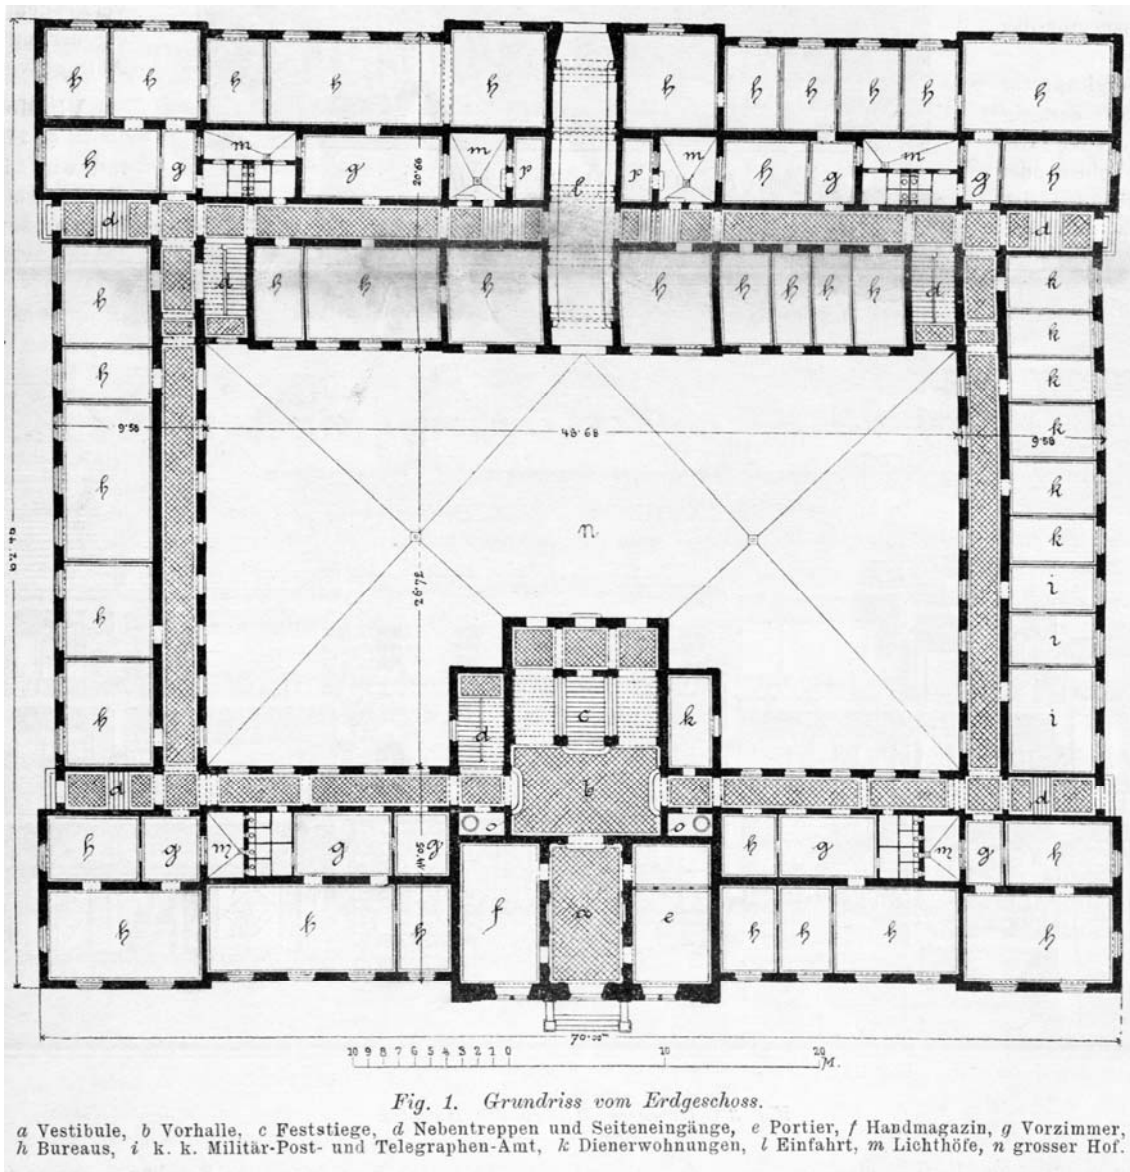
Sarajevo, Erstes Landesregierungsgebäude, Grundriss Erdgeschoss
